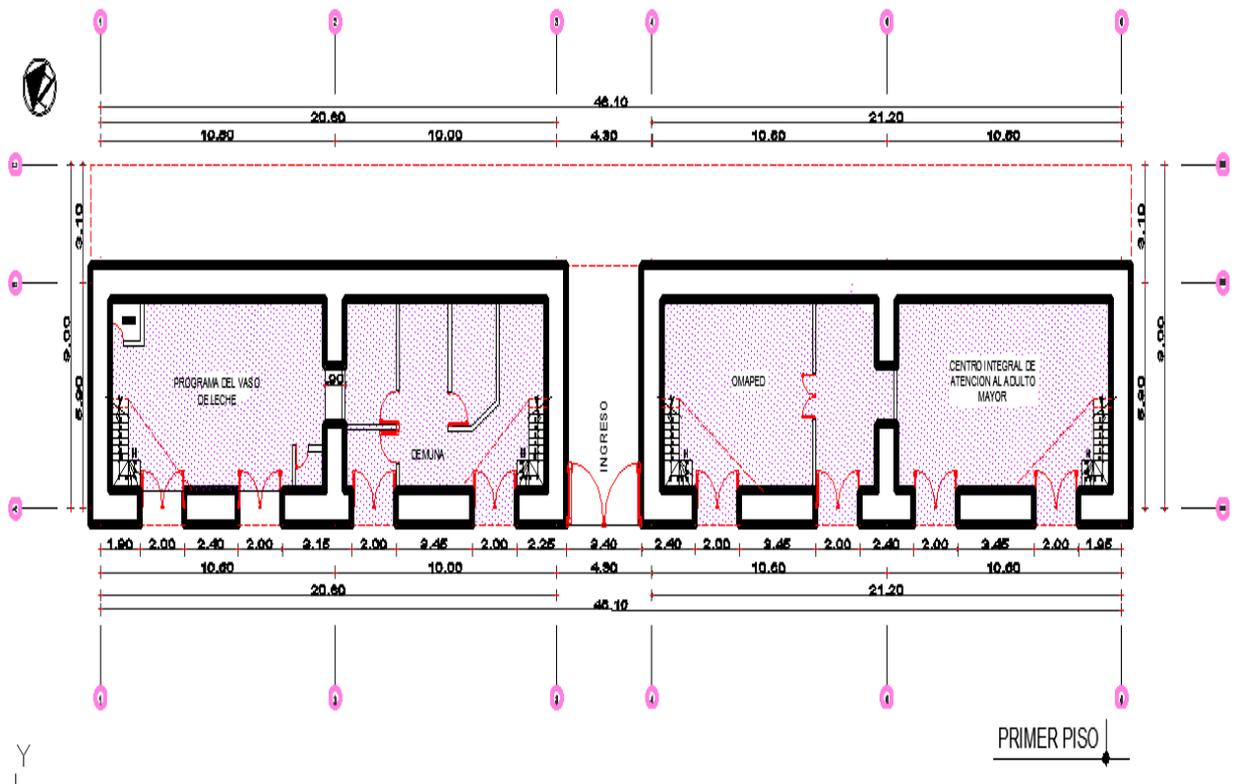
Planta Arquitectónico Principal 1er Piso.
